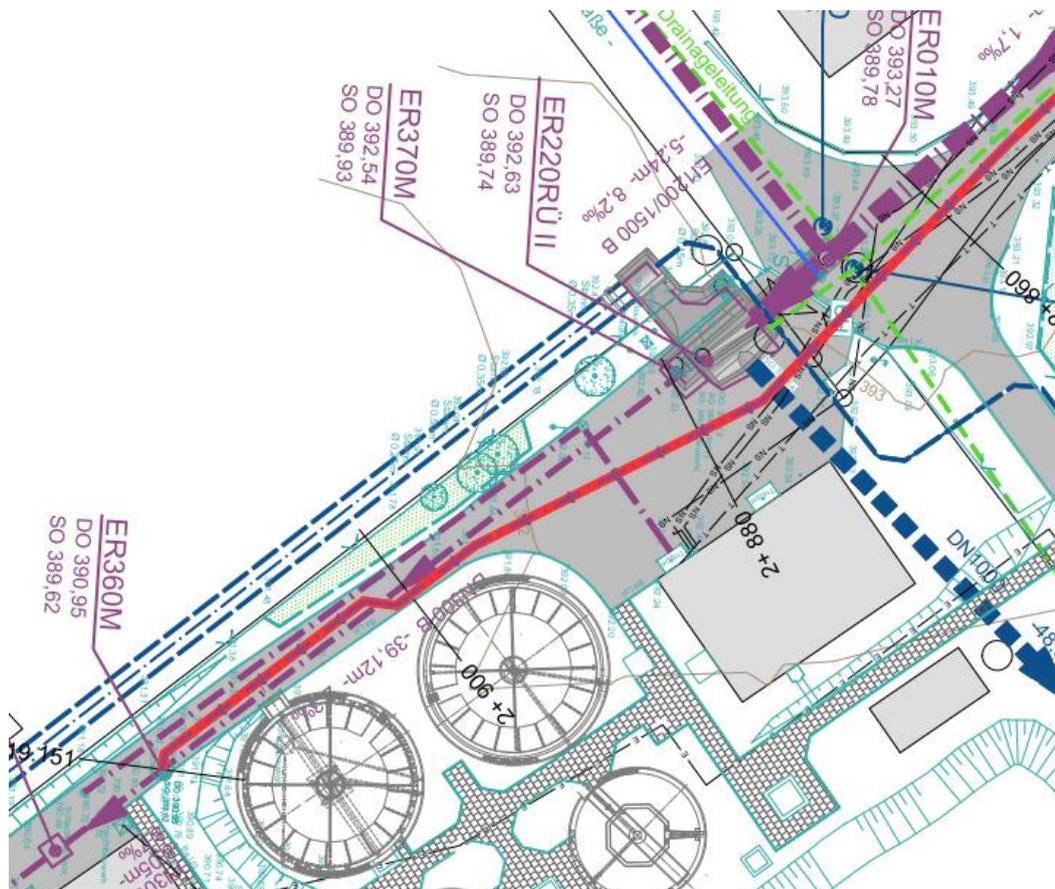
Übersicht zum Verlauf der Druckleitung (rot) auf der Kläranlage Hohenwart
